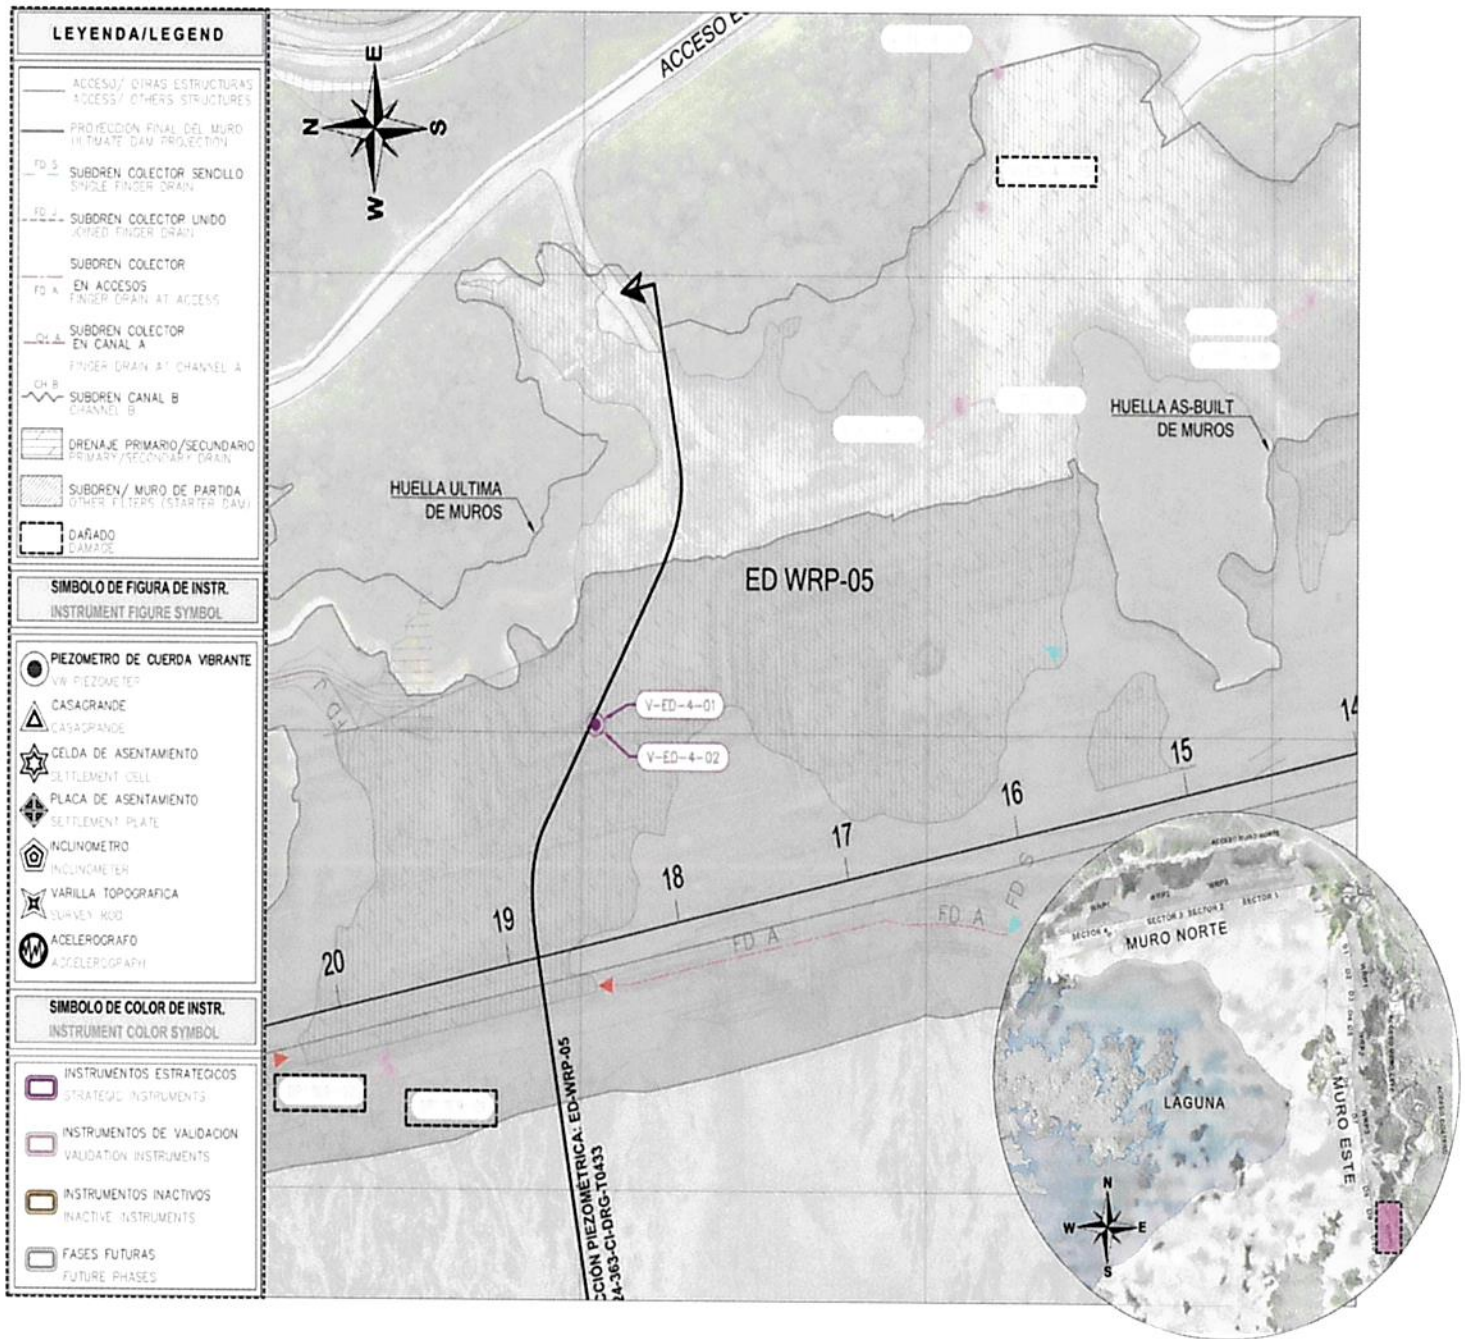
Vista de Planta en el Muro Este WRP5 con Piezómetros
